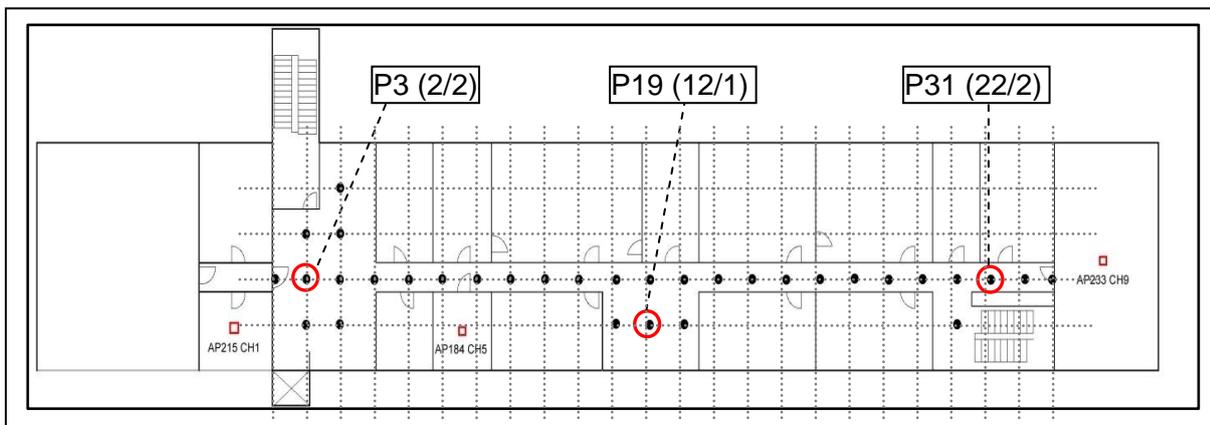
Grundriss der Etage mit Messpositionen
